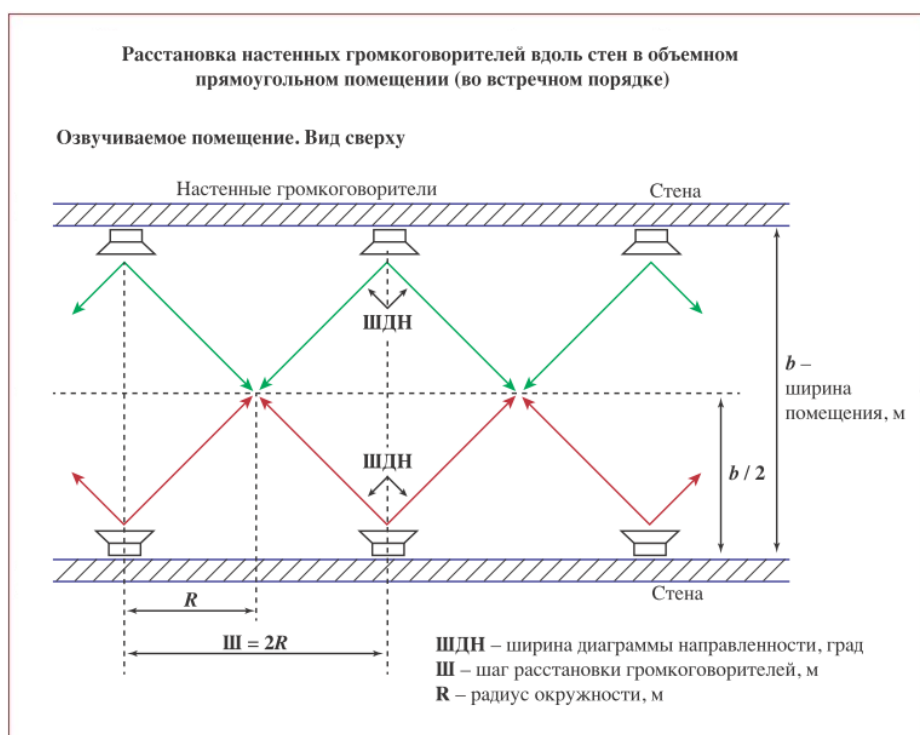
Расстановка настенных громкоговорителей вдоль стен в объемном прямоугольном помещении (во встречном порядке).
